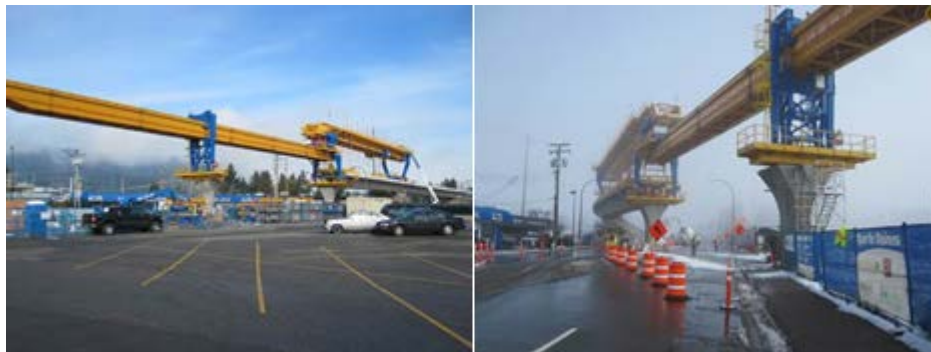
Technique envisagée pour la pose des voussoirs
